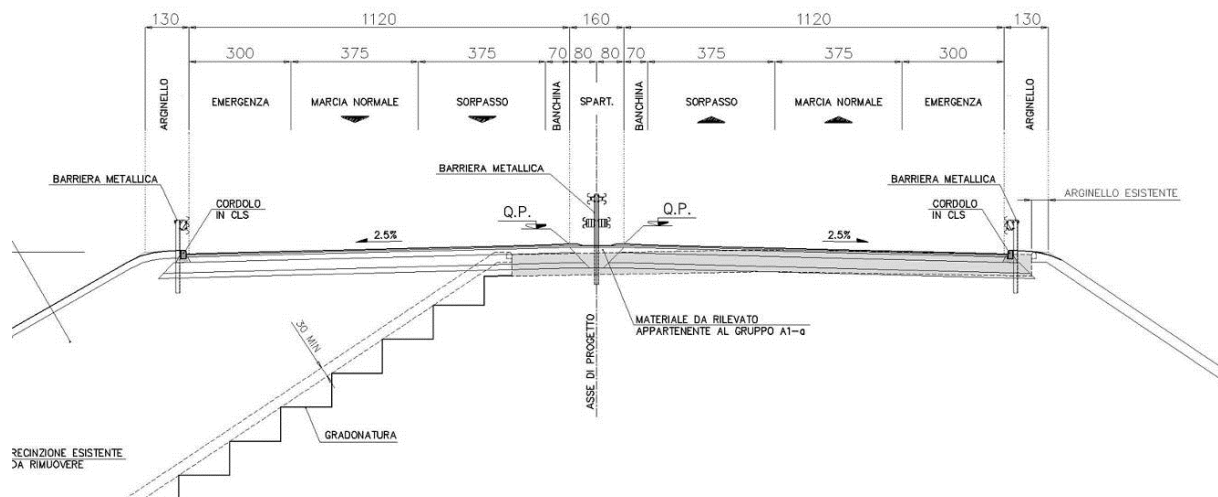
Sezione tipo di progetto (adeguamento asimmetrico SS1 Aurelia)
